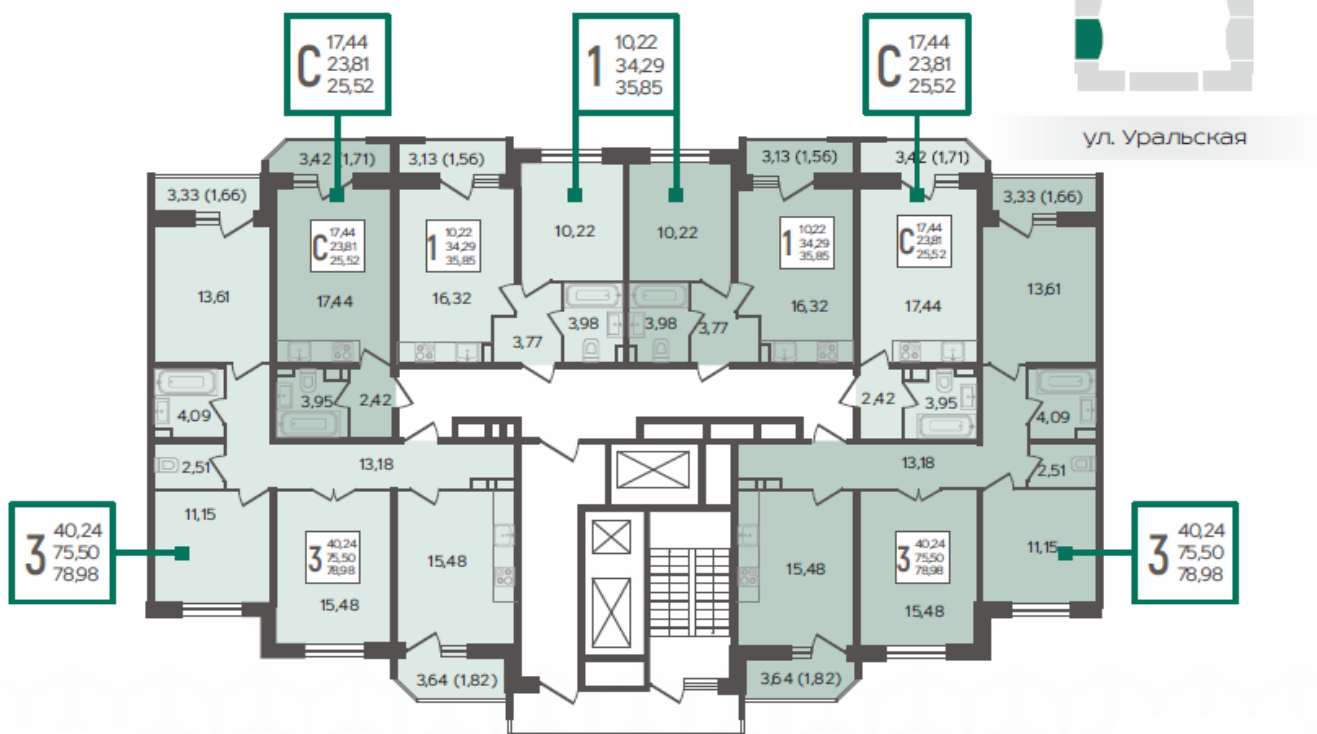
План 2 этажа БС-2 ЖК URAL
